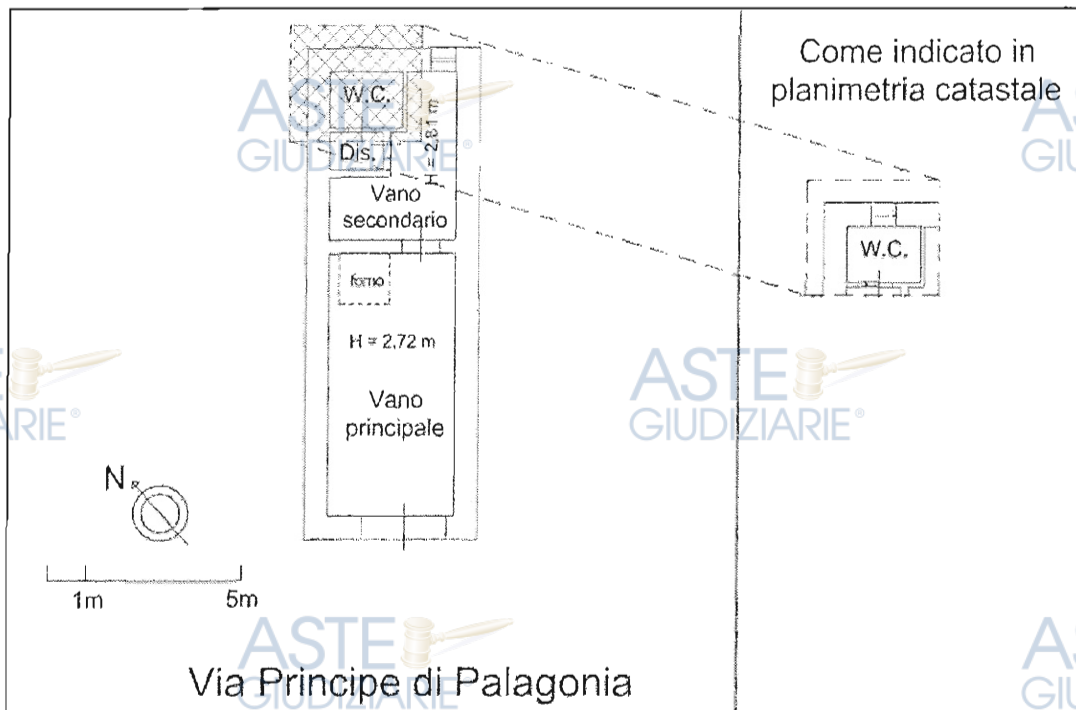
Estratto planimetria catastale (ALLEGATO 4)
